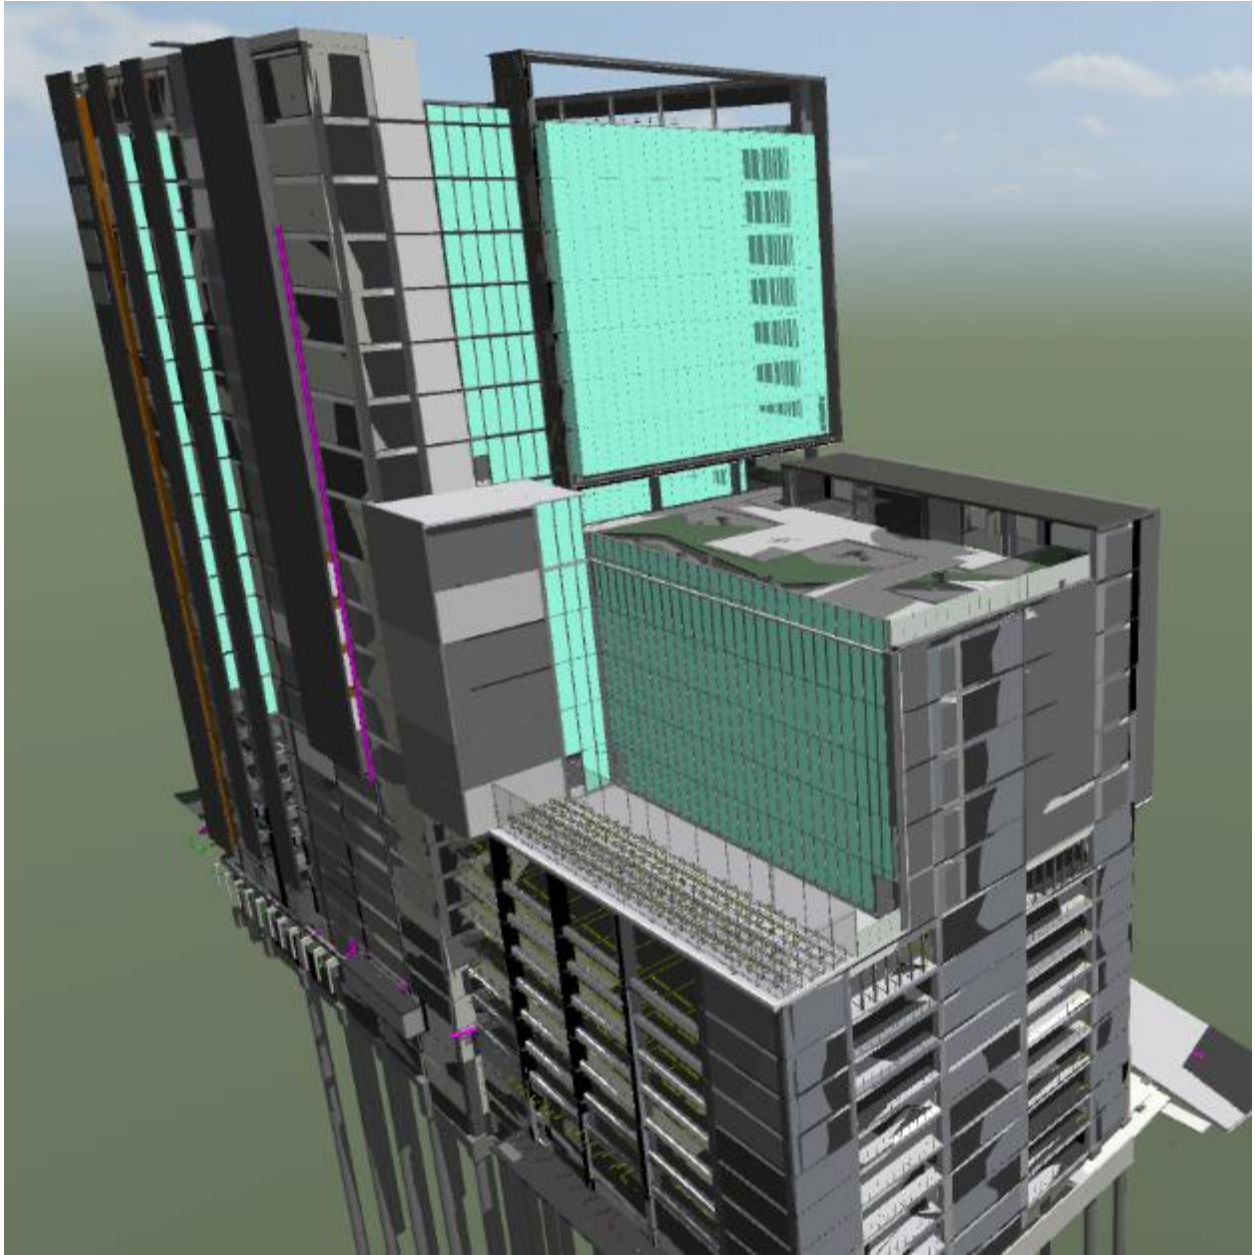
Fachada suroeste. Fuente: Extralum (2019)
